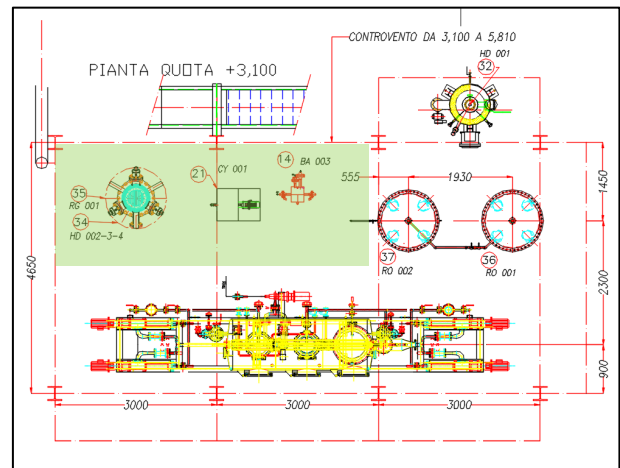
Pianta dell'area dell'impianto a quota 3100.
